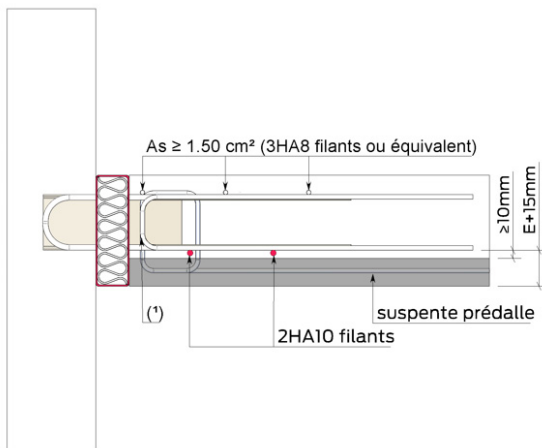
Exemple de détail de ferrailage de prédalle avec suspente (3) + chaînage de plancher (2)
